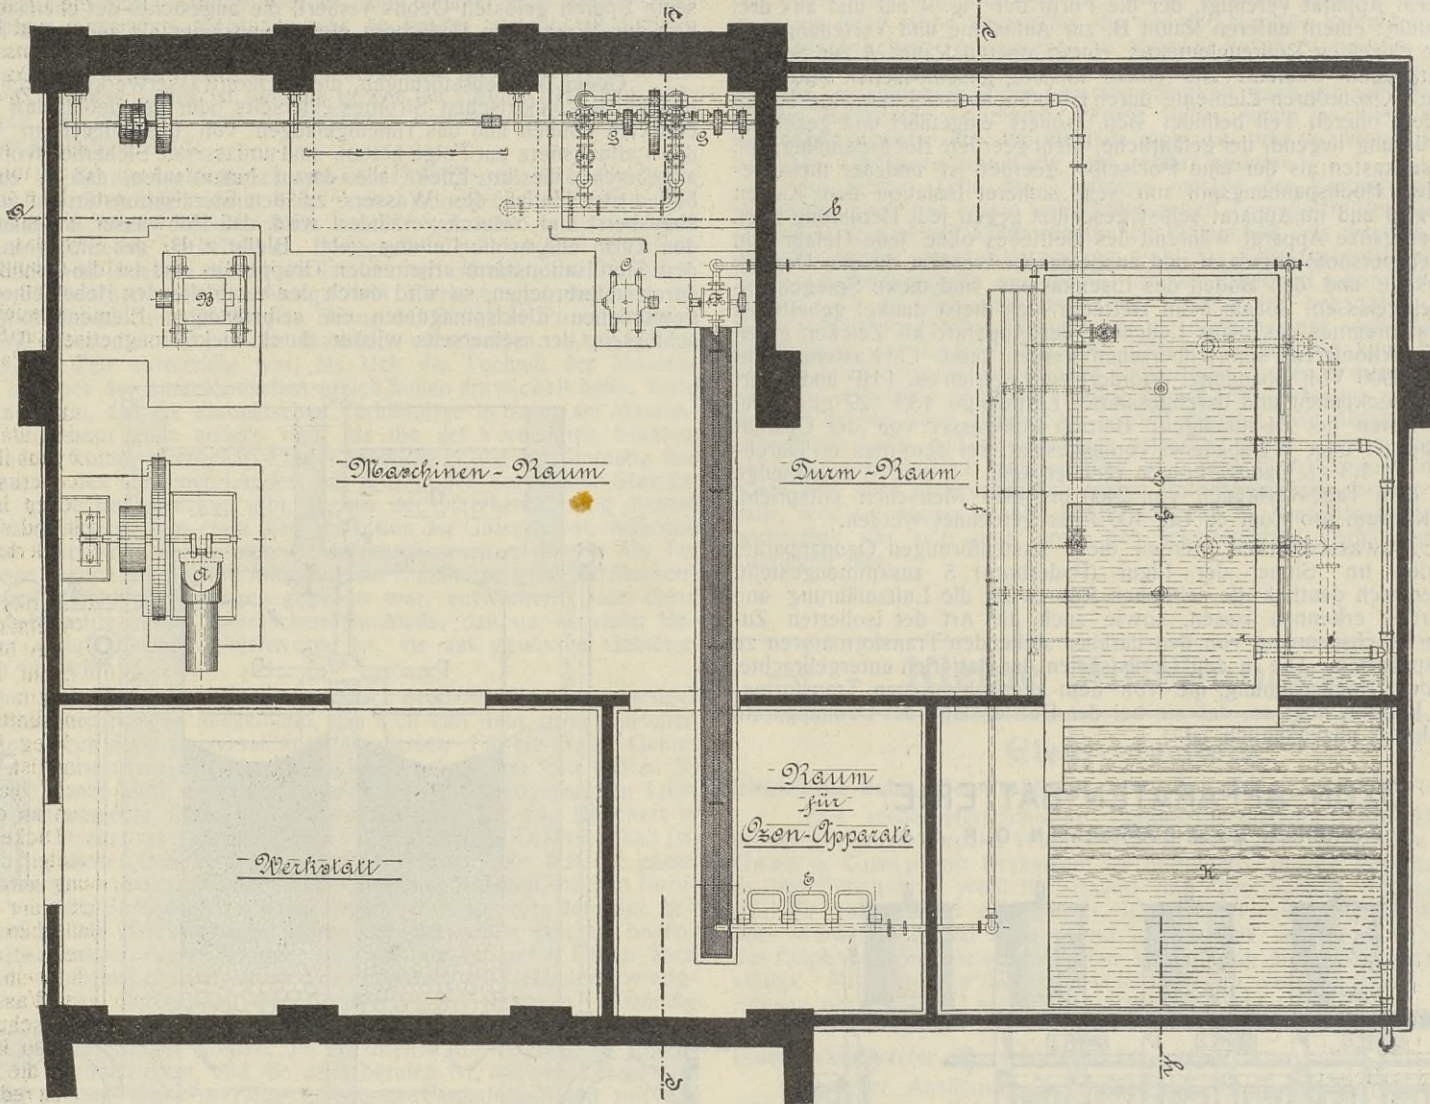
Grundriß des Ozonwasserwerks Paderborn.
